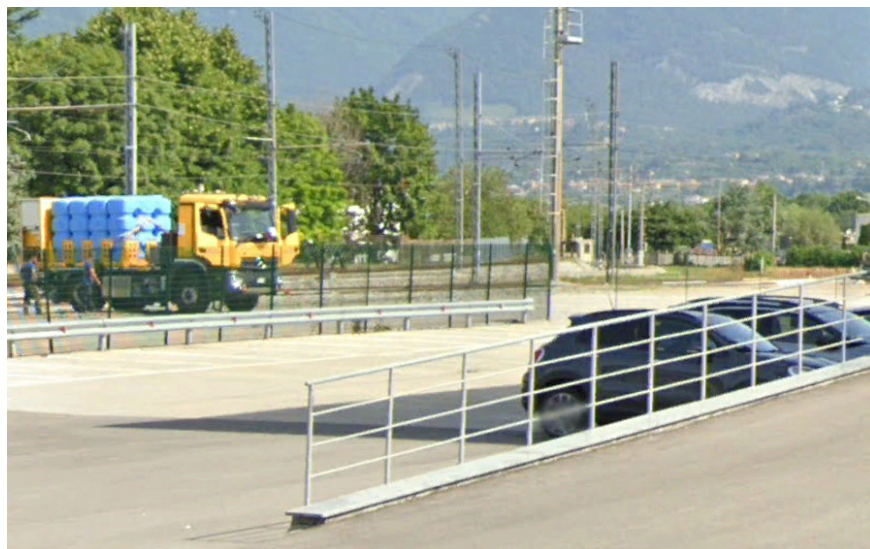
vista dell'area di cantiere (fonte Google Earth)
